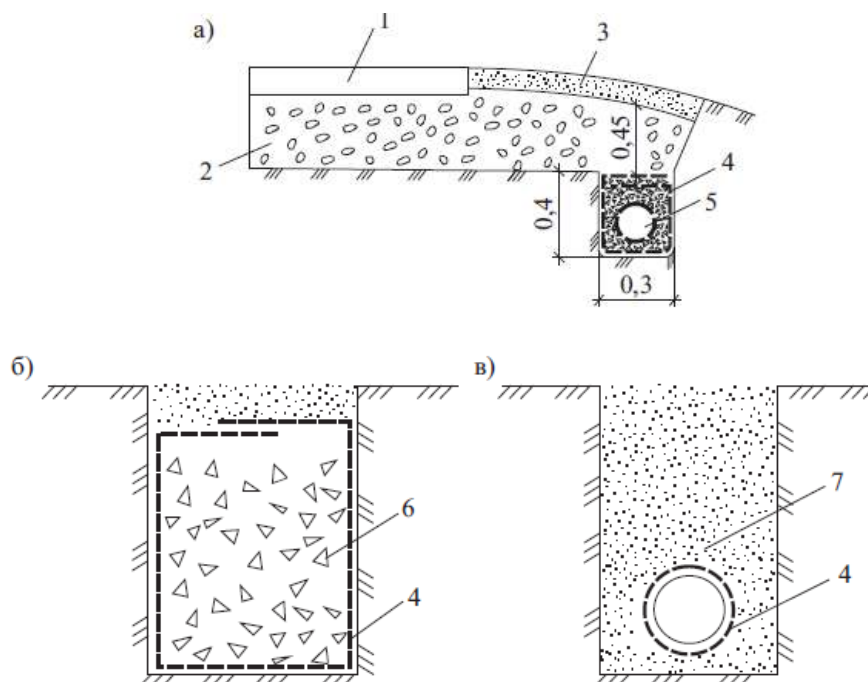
Схемы расположения геотекстильных фильтров в траншейных дренажах
